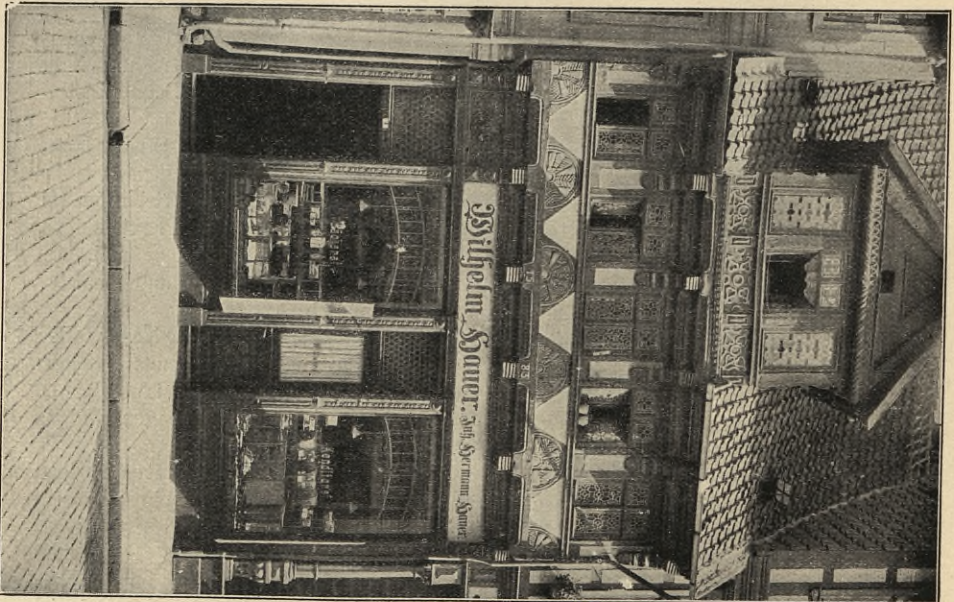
Fachwerkhaus, durch Ladeneinbau entstellt.
